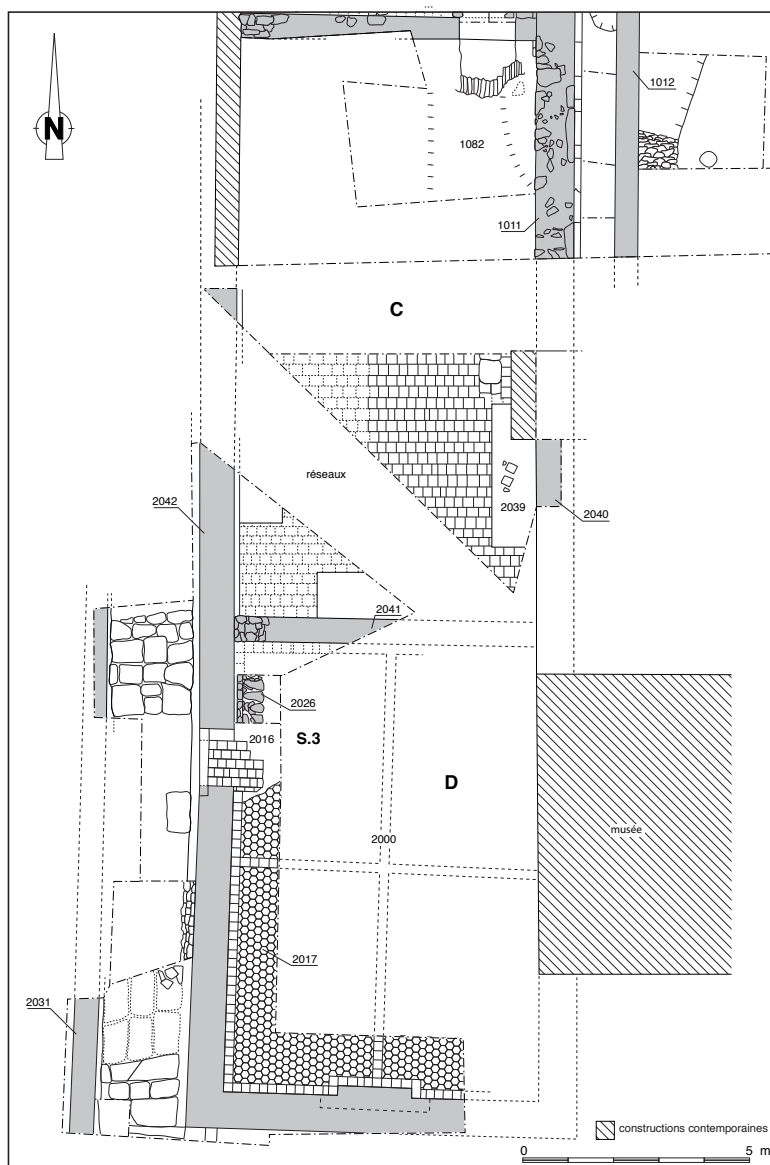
Plan du secteur sud : les salles C et D et la galerie.
